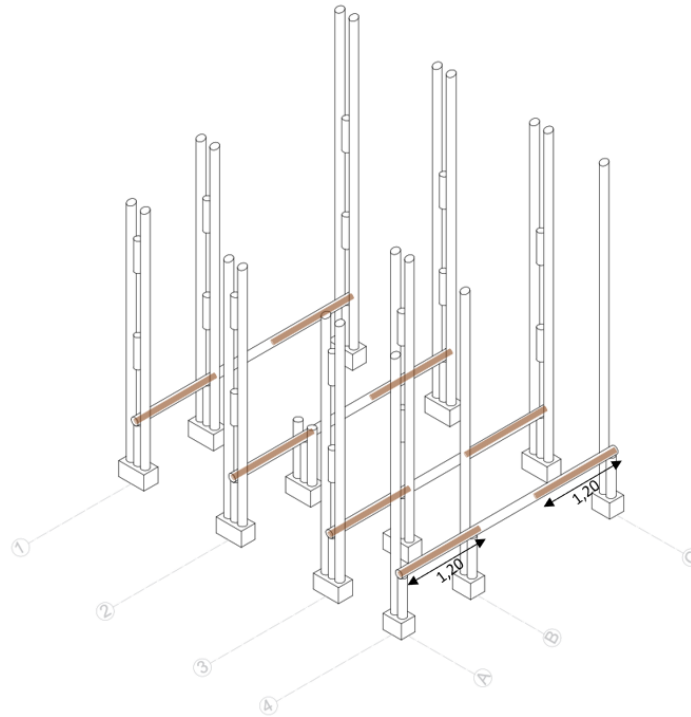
Refuerzo de vigas principales de entrepiso de guadua con troncos de madera de menor diámetro.
